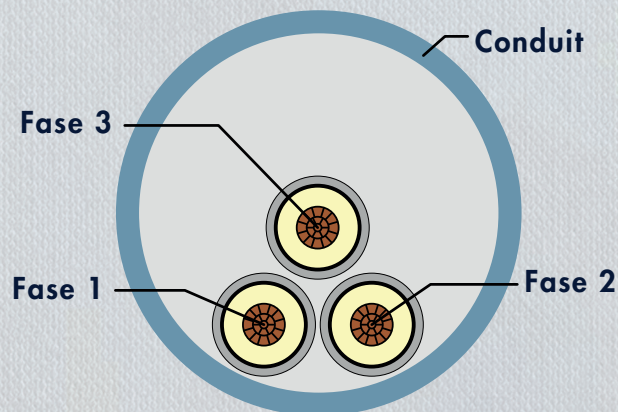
Instalación en conduit de Cables para Media Tensión
